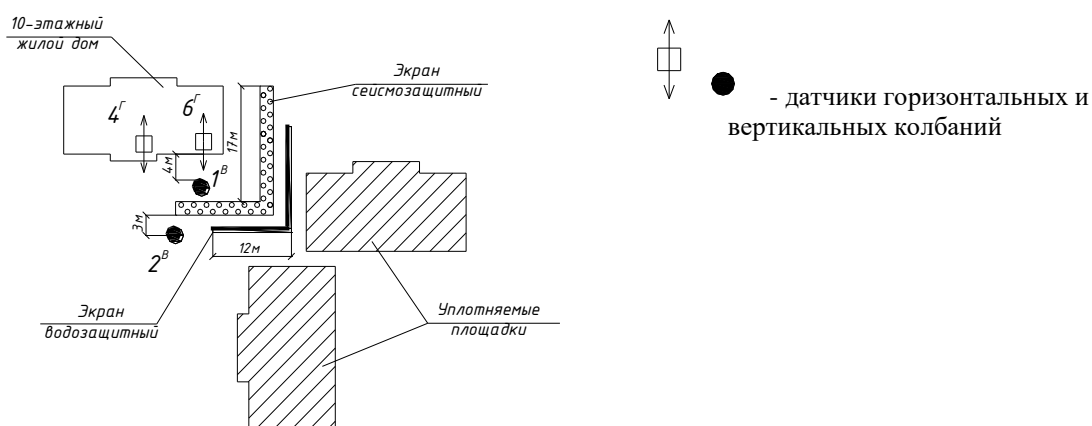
Схема размещения сейсмоприемников на грунте у сейсмозащитного экрана и в 10-этажном доме
